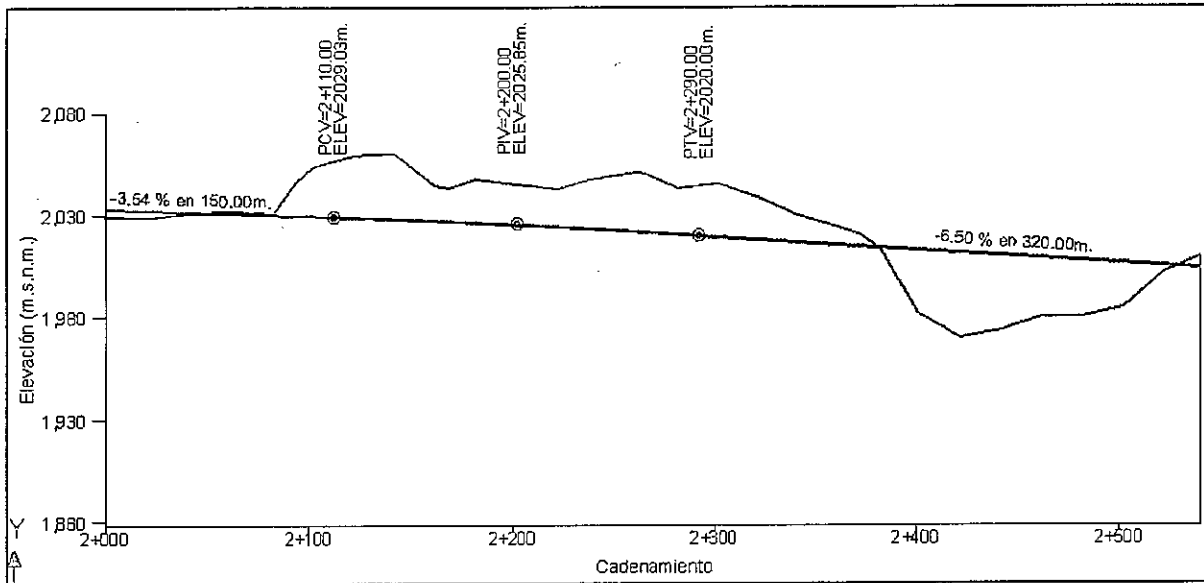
Perfil topográfico por el eje del camino en Corte 1
